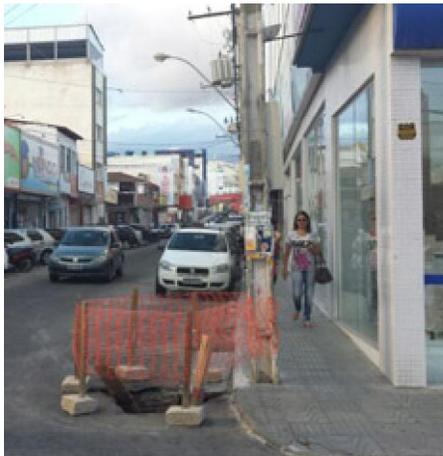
Obras na pavimentação devido as inundações no centro de Vitoria da conquista, Bahia.
